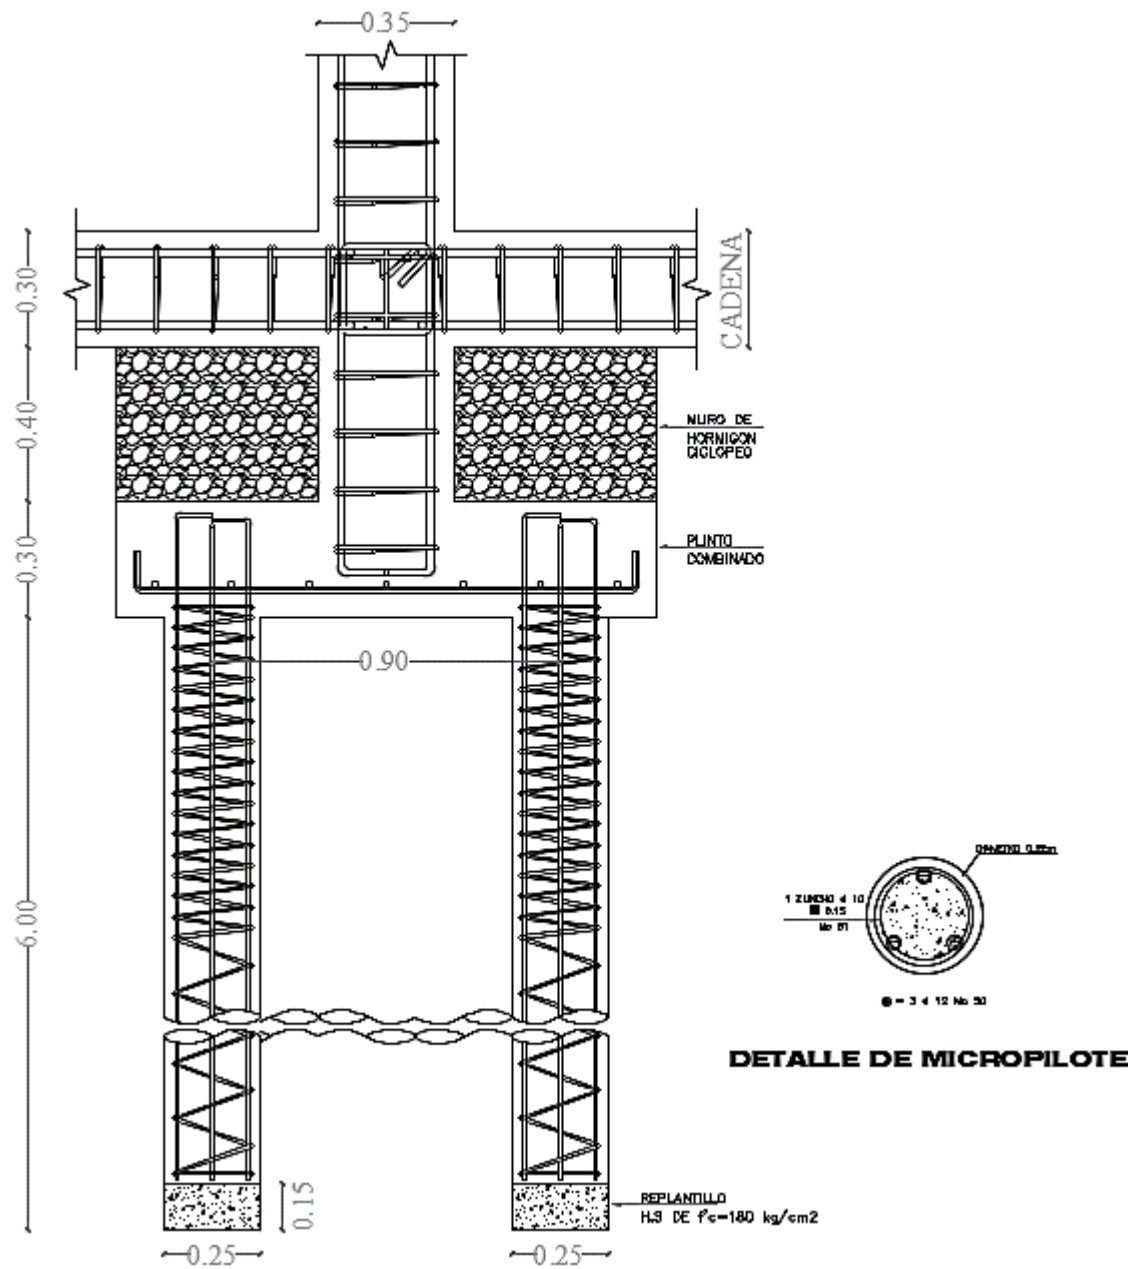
Vista en corte detalle de conexión y armado entre plintos y micropilotes
